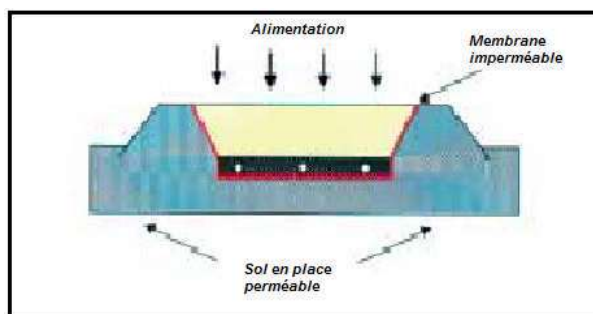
Système drainé avec un massif drainant étanché par une membrane Imperméable[27]
